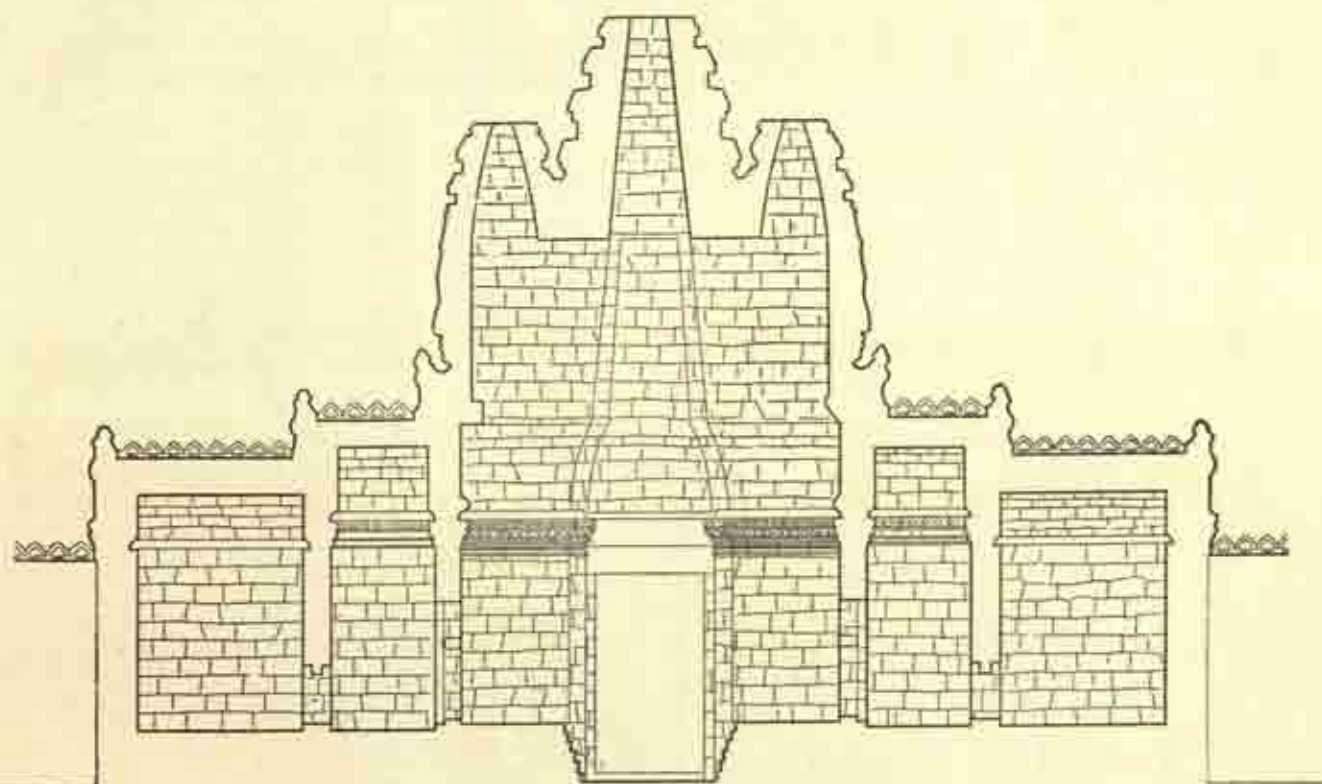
Coupe longitudinale sur la porte des Morts. (Dessin de Jean Commaille.)
